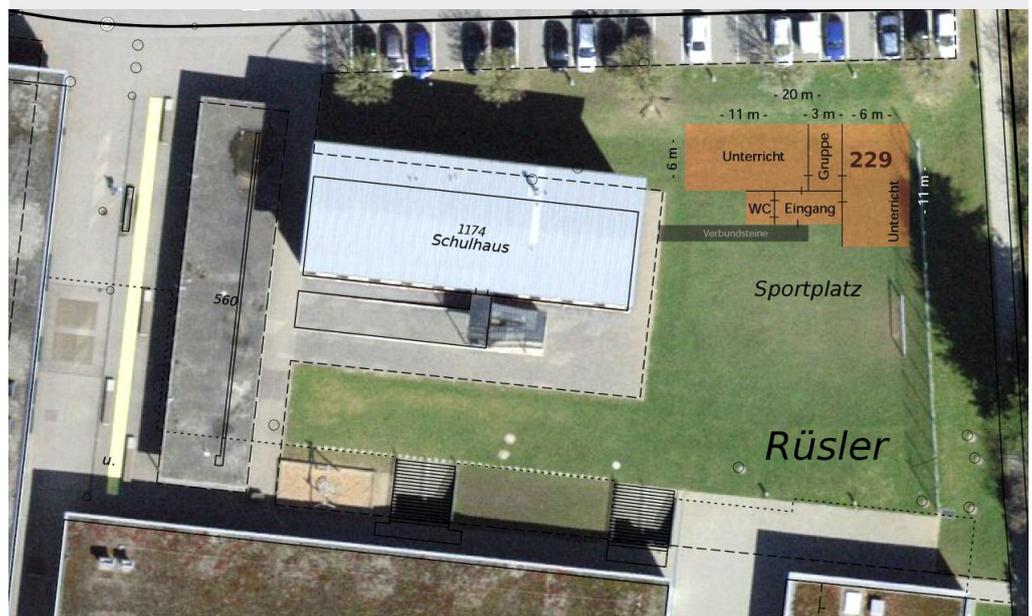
Grundrissvariante Containerprovisorium Standort 7
